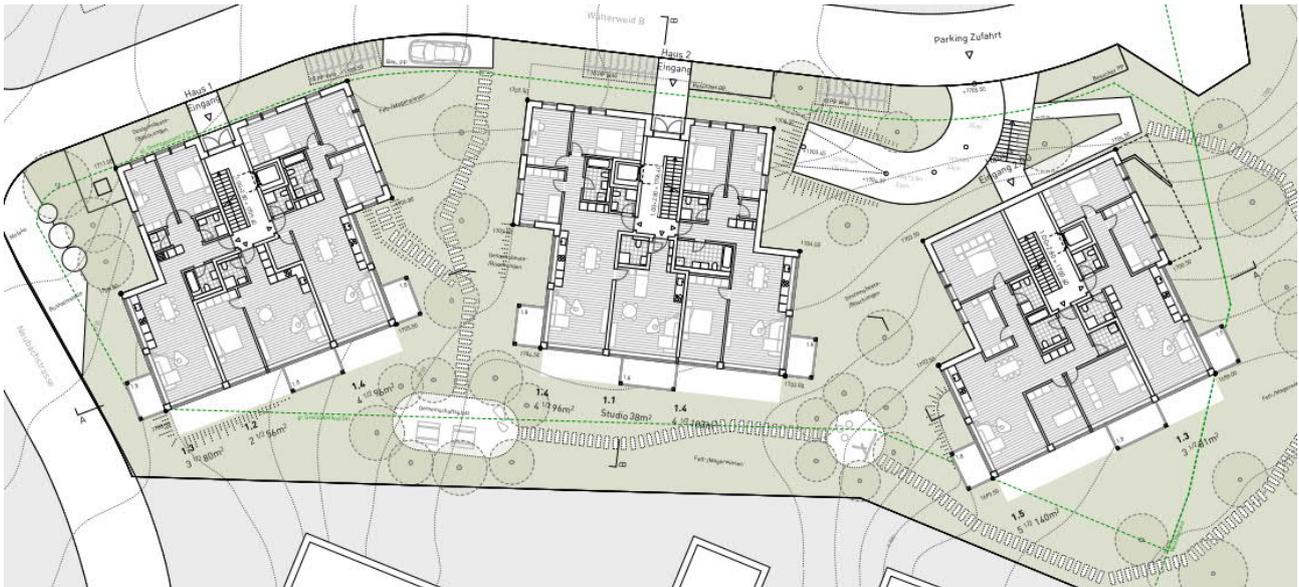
Regelgeschoss (1. OG) ZAI (massstabslos)
